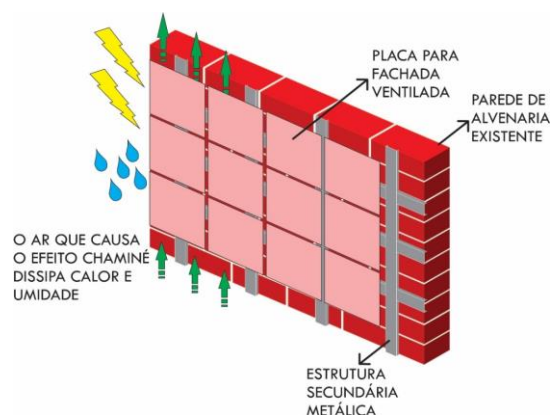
Esquema do sistema de fachada ventilada. Fonte: Adaptado de TRESPA (2016)
